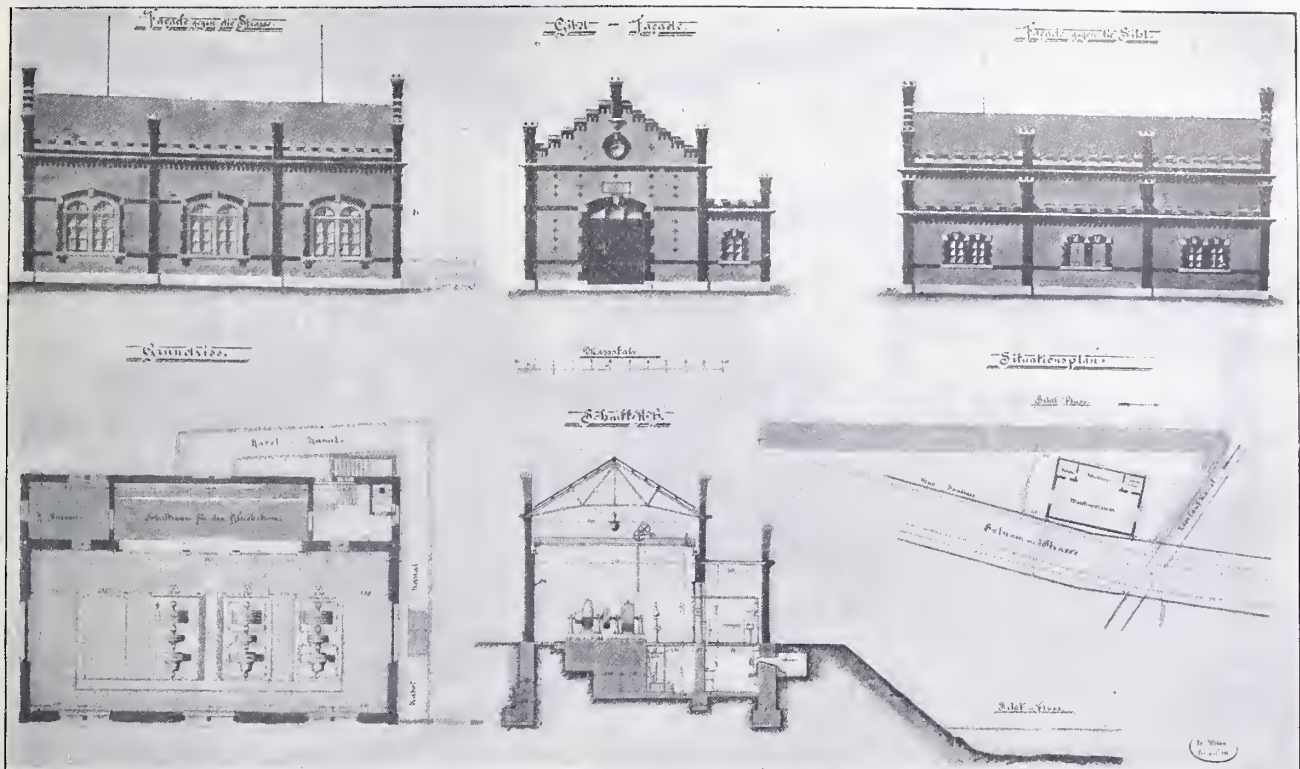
Umformerstation. — Lageplan, Grundriss, Fassaden und Querschnitt 1 : 400.
